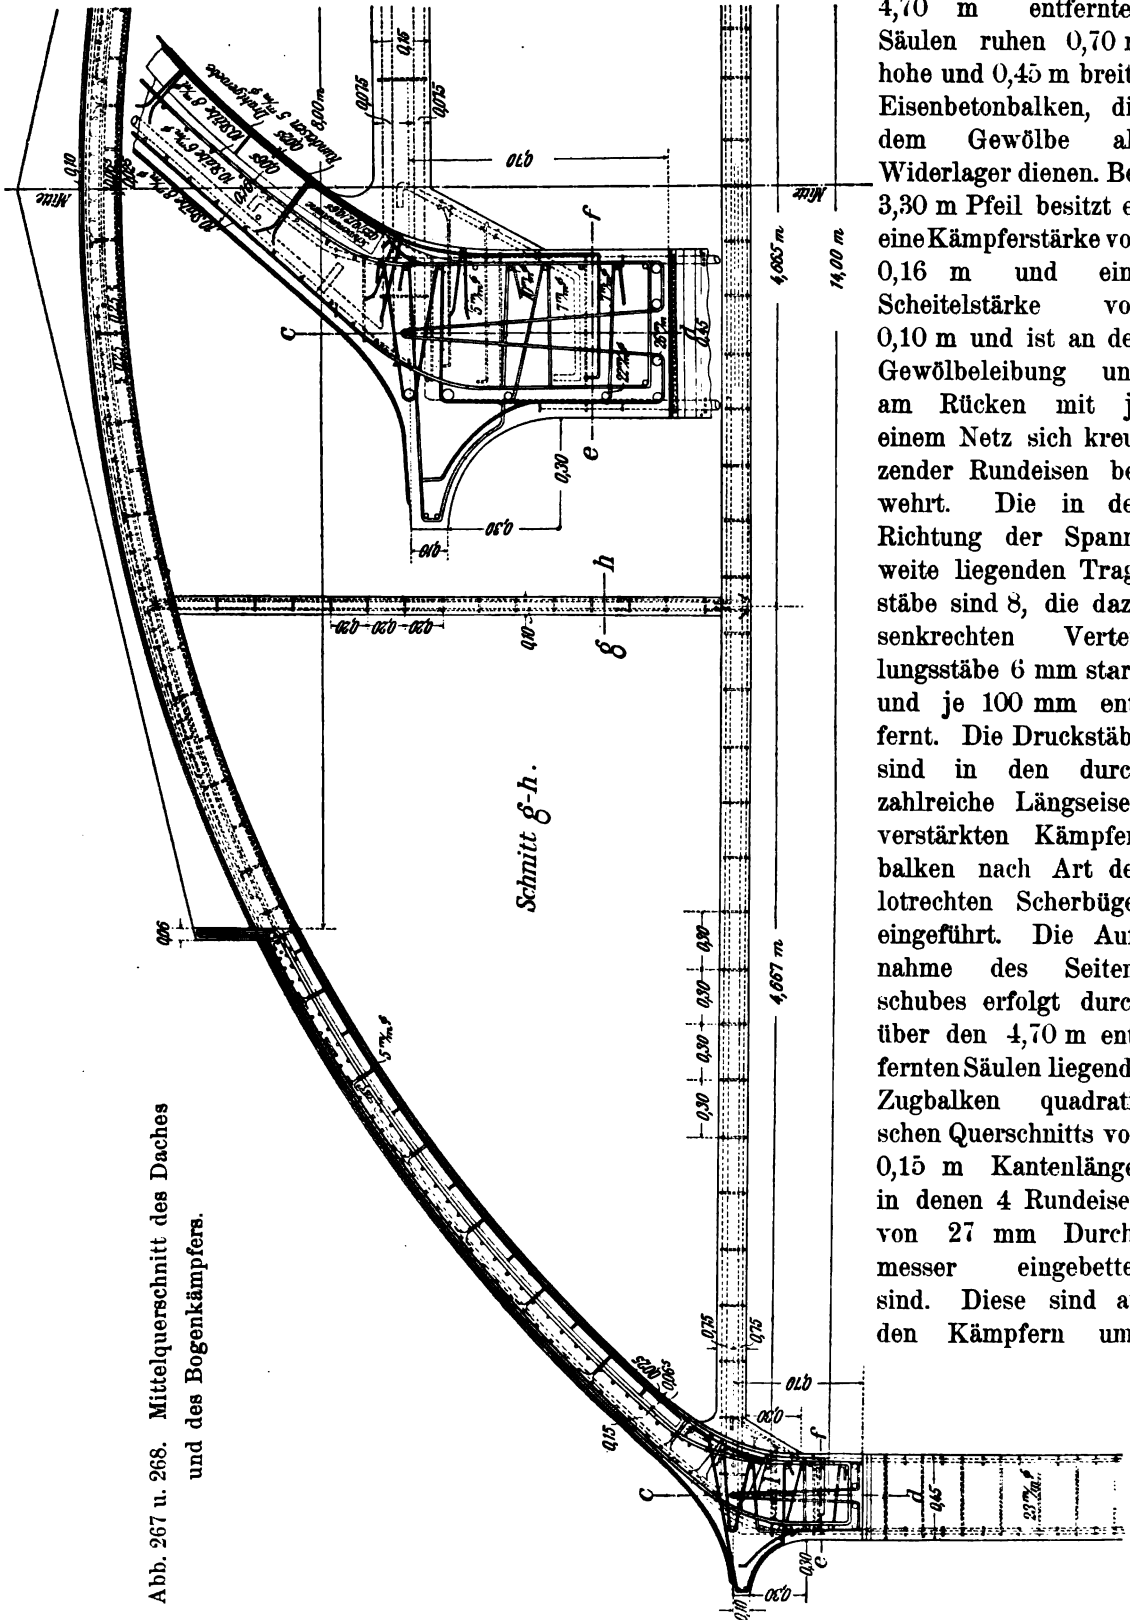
u. 268. Mittelquerschnitt des Daches und des Bogenkämpfers.
